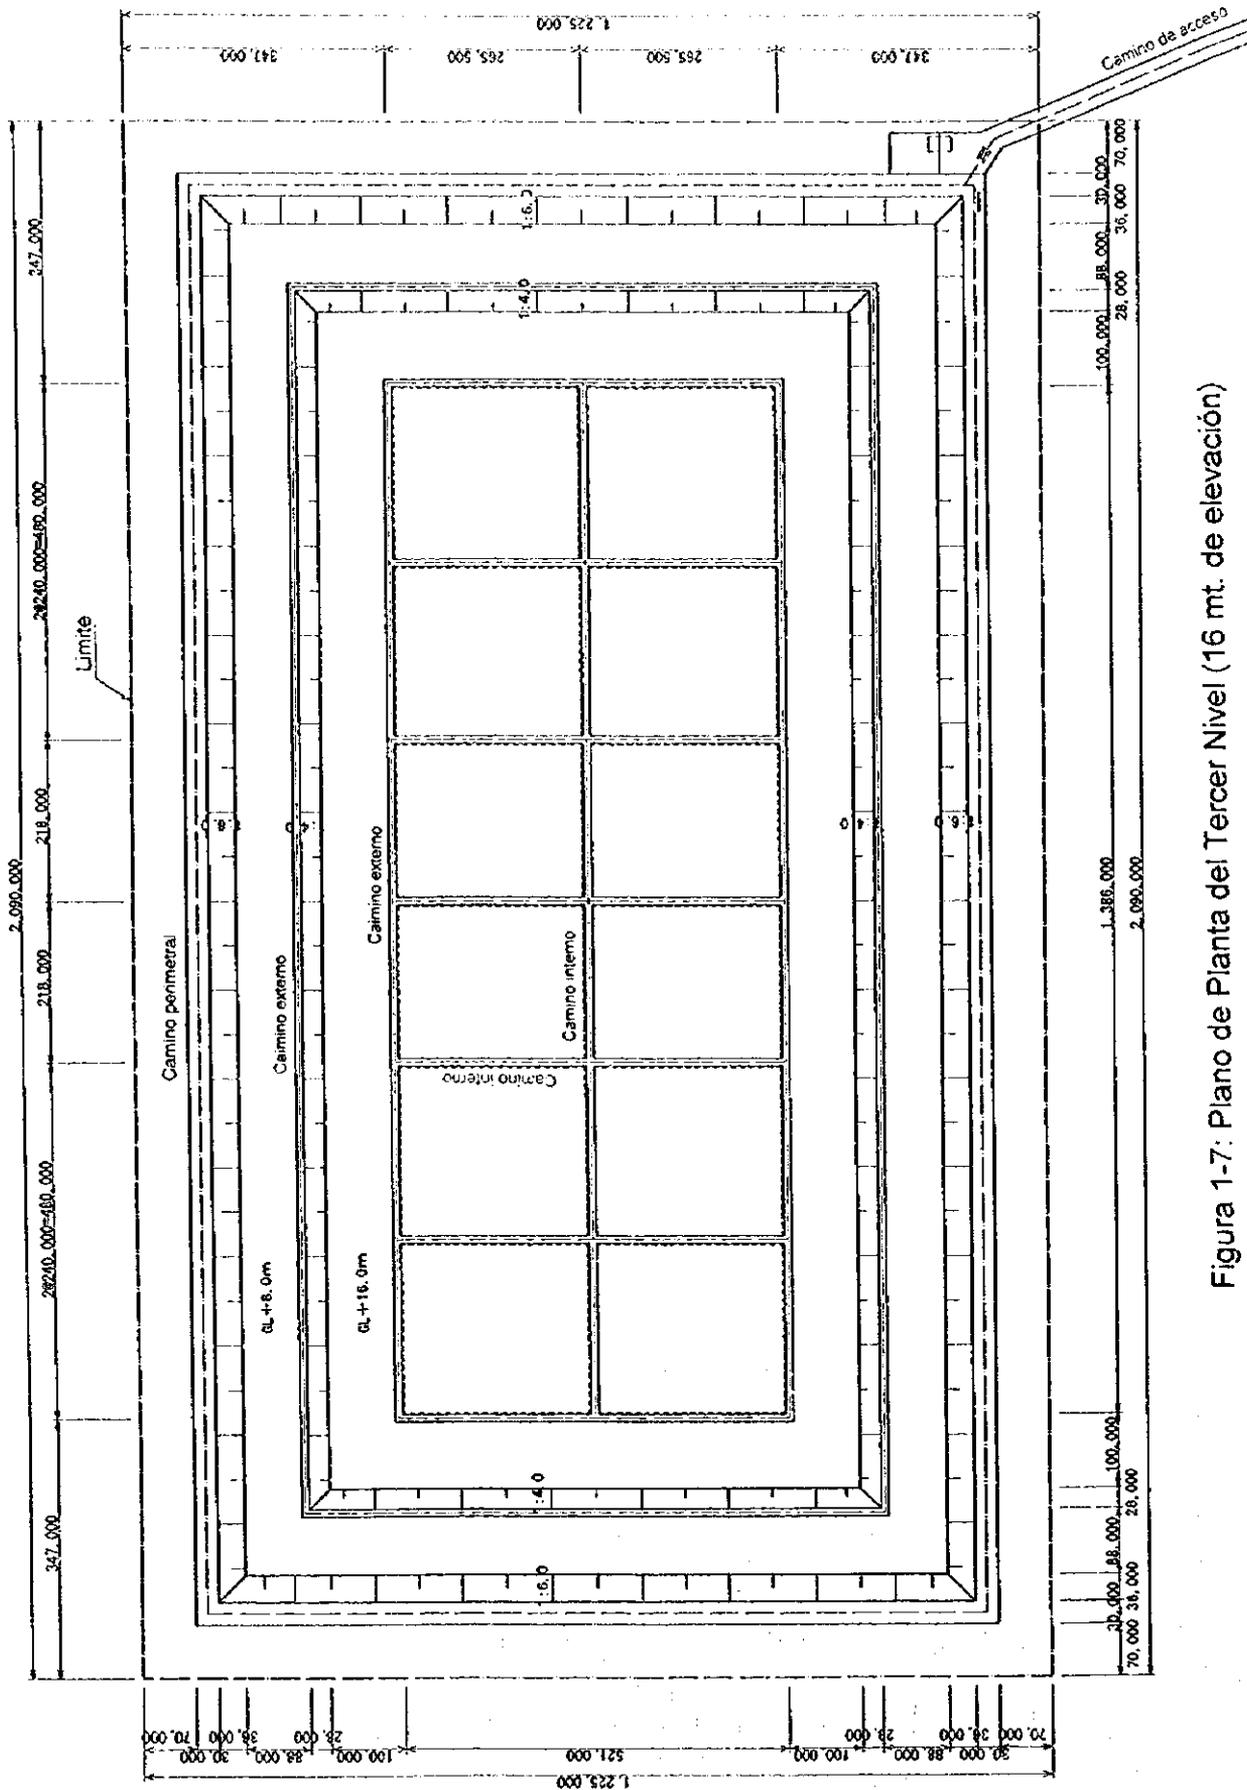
Plano de Planta del Tercer Nivel (16 mt. de elevación)
